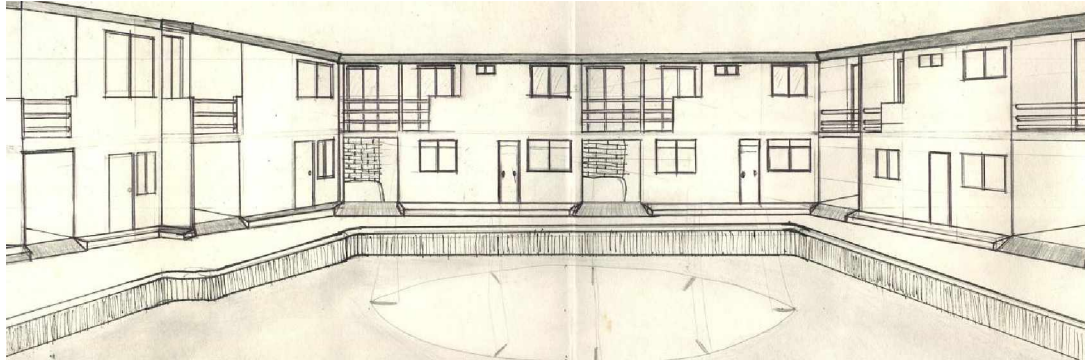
BOCETO DE FACHADAS DE CONJUNTOS EN PERSPECTIVA.
